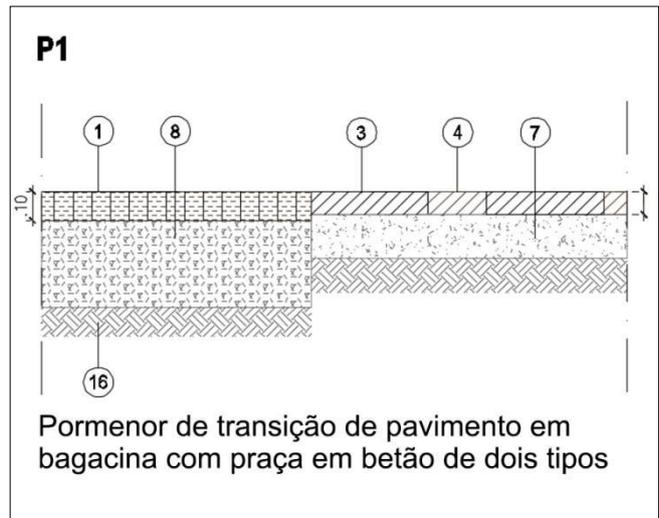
Pormenores de Construção do Projeto de espaços exteriores no Museu Francisco Lacerda, Açores
